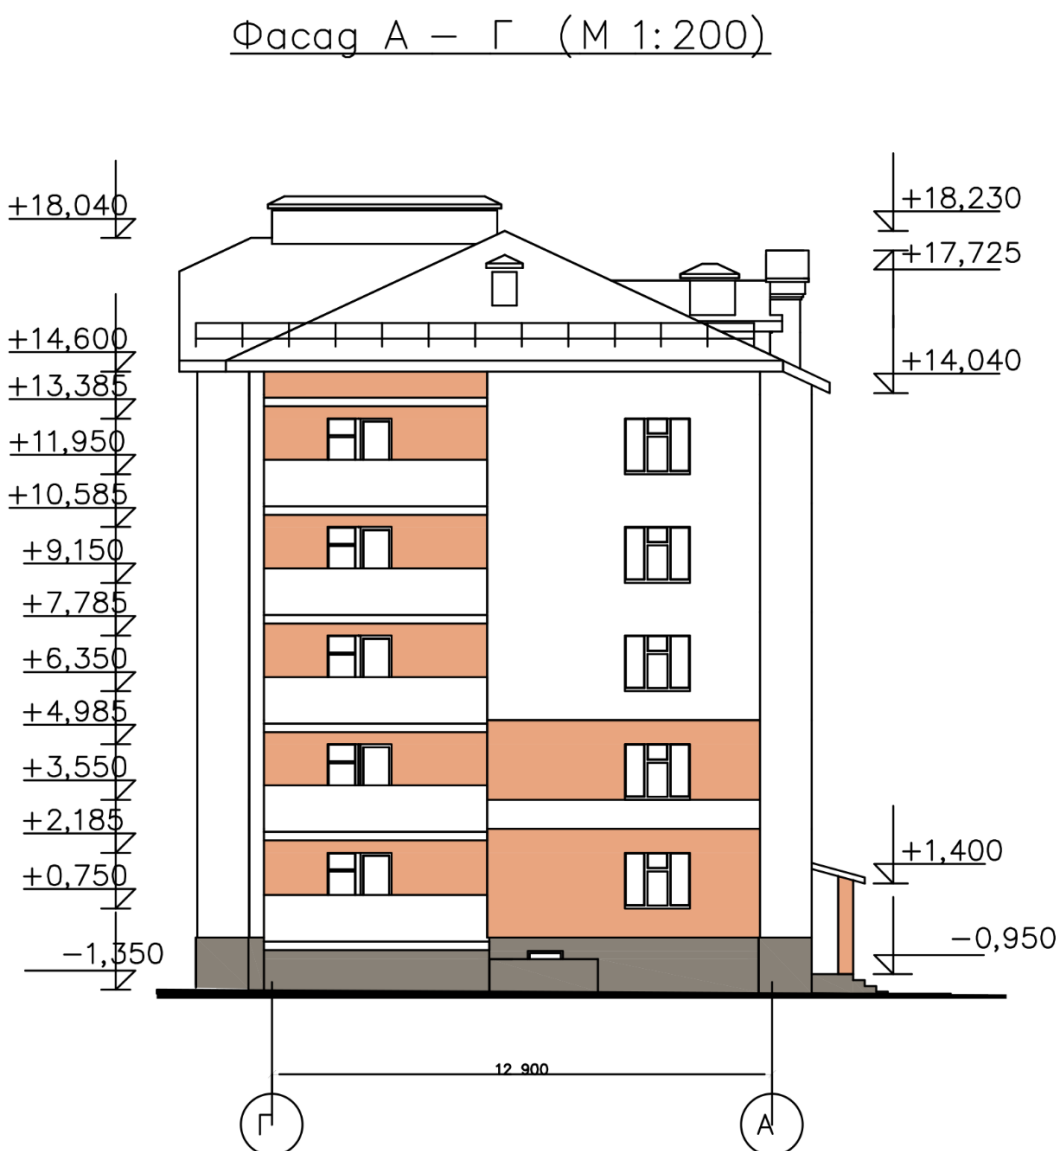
Фасад п'ятиповерхових будинків №1 і №2
